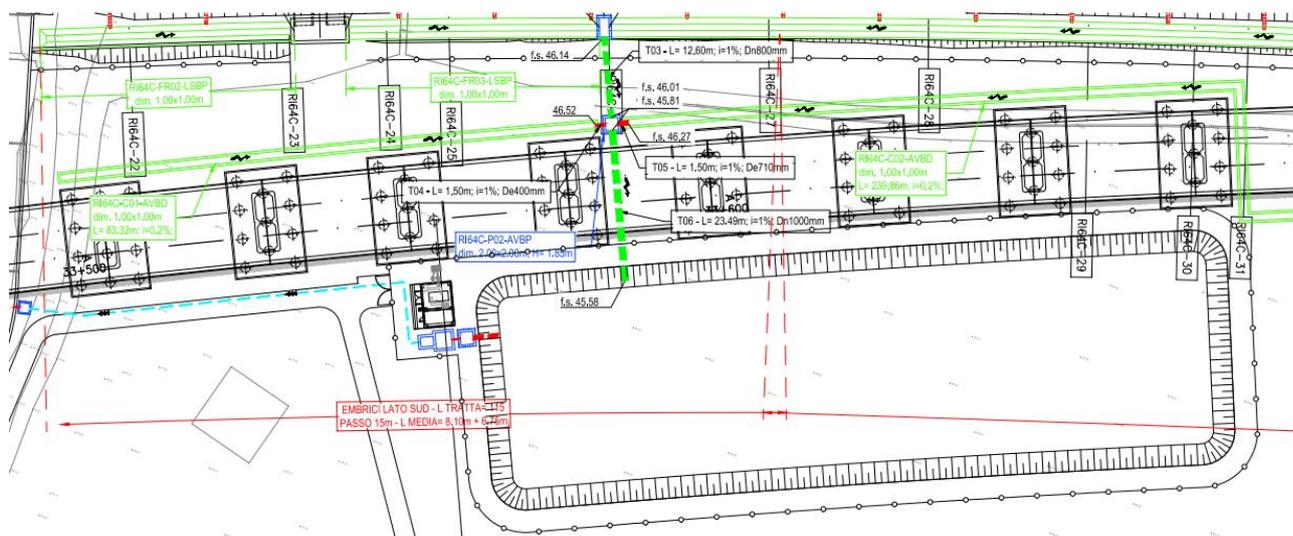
Planimetria del bacino di laminazione RI64C-BL01
